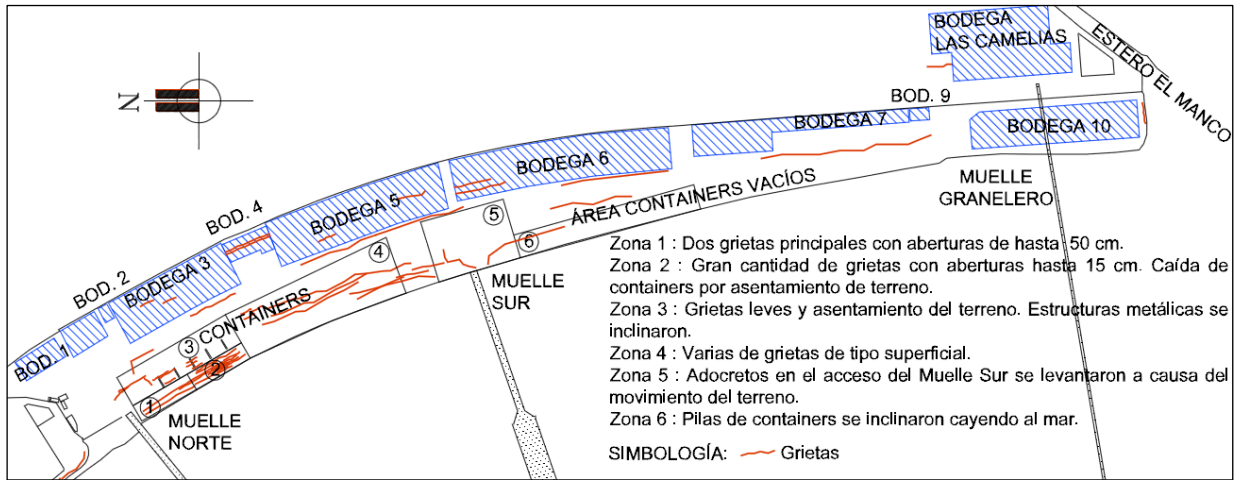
Distribución de las principales grietas en las instalaciones del Puerto.
